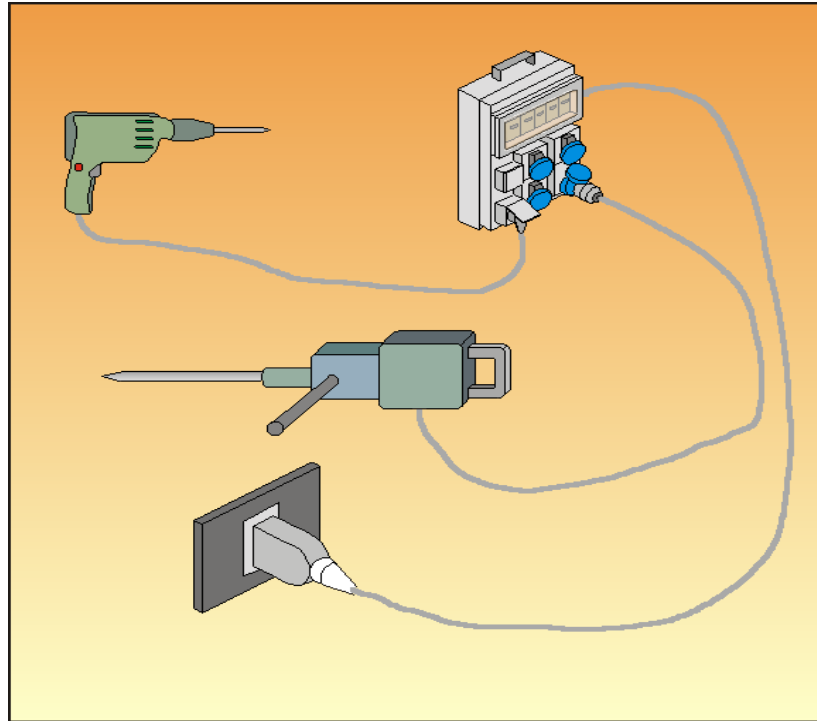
Quadretto alimentato direttamente dall'impianto esistente
